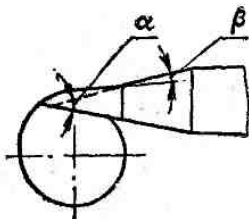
Схема присоединения к вентилятору или дымососу нагнетательной части газозухопровода
